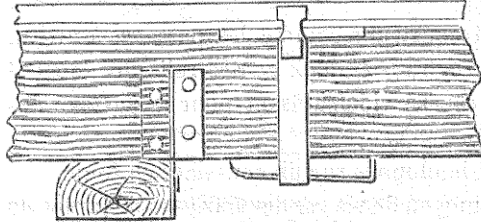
Tramways de Versailles. Système Franco-Rail, etc. Échelle 1/8.
